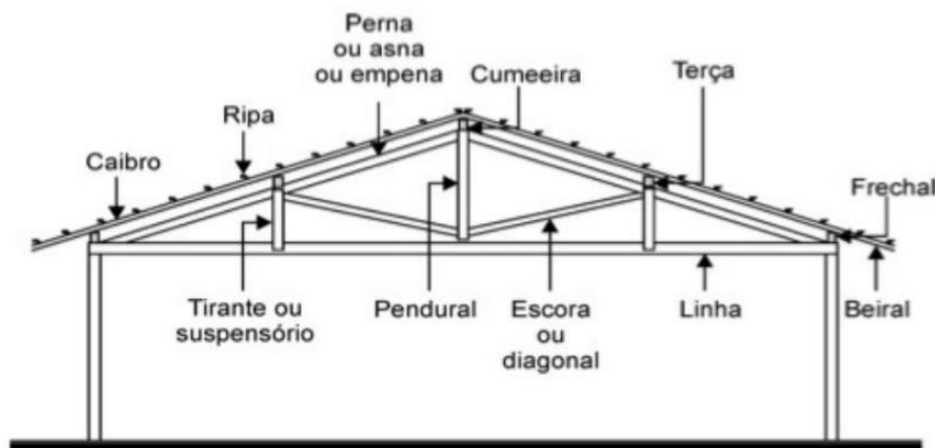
Elementos de um telhado (Fonte: SALGADO, 2019)
